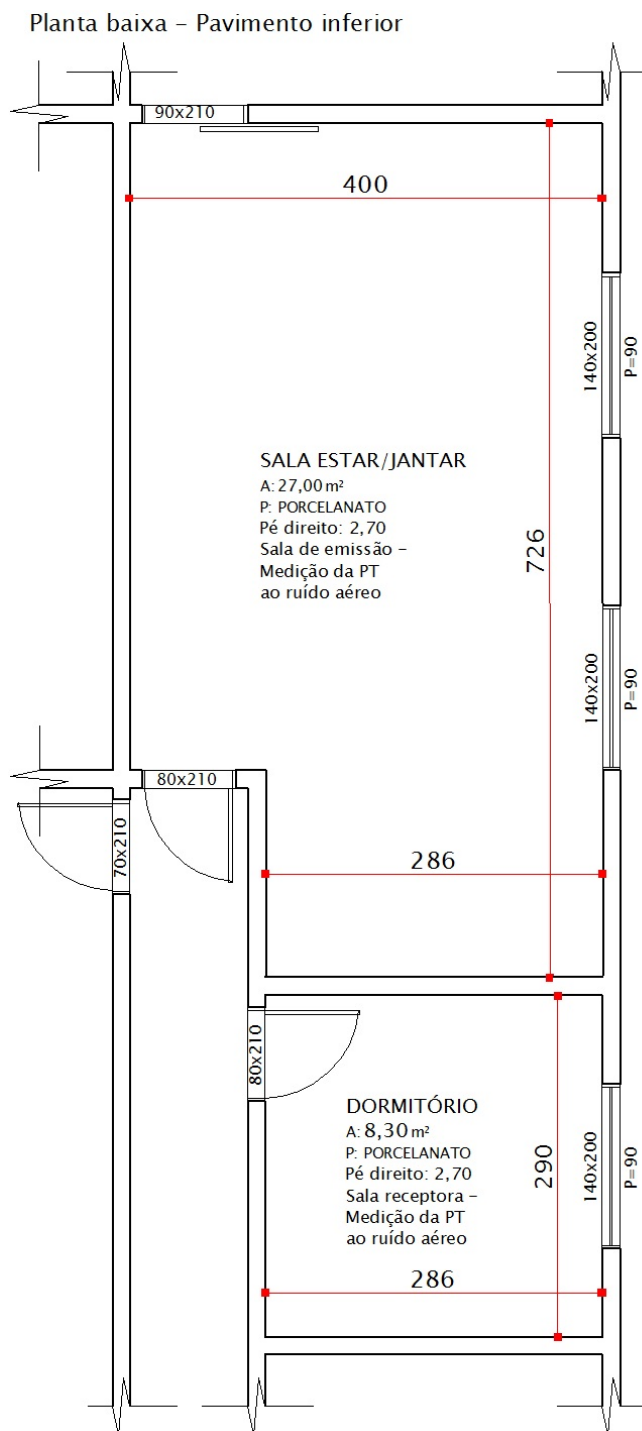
Planta baixa - pavimento tipo - 20-R8-A-TV
